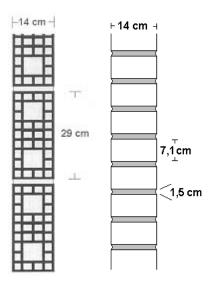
Vista en planta y corte respectivamente de pared divisoria
